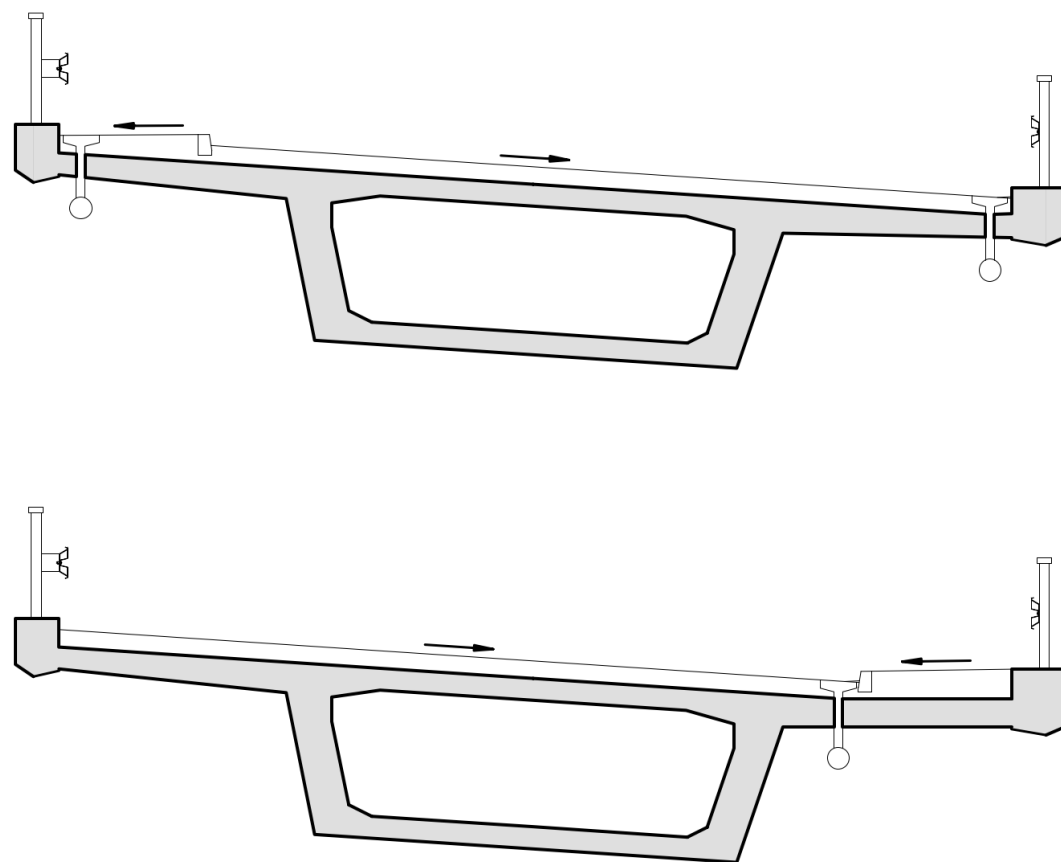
Récupération des eaux de chaussée avec un contre-dévers, dans le cas d'un trottoir au point haut et d'un trottoir au point bas.
